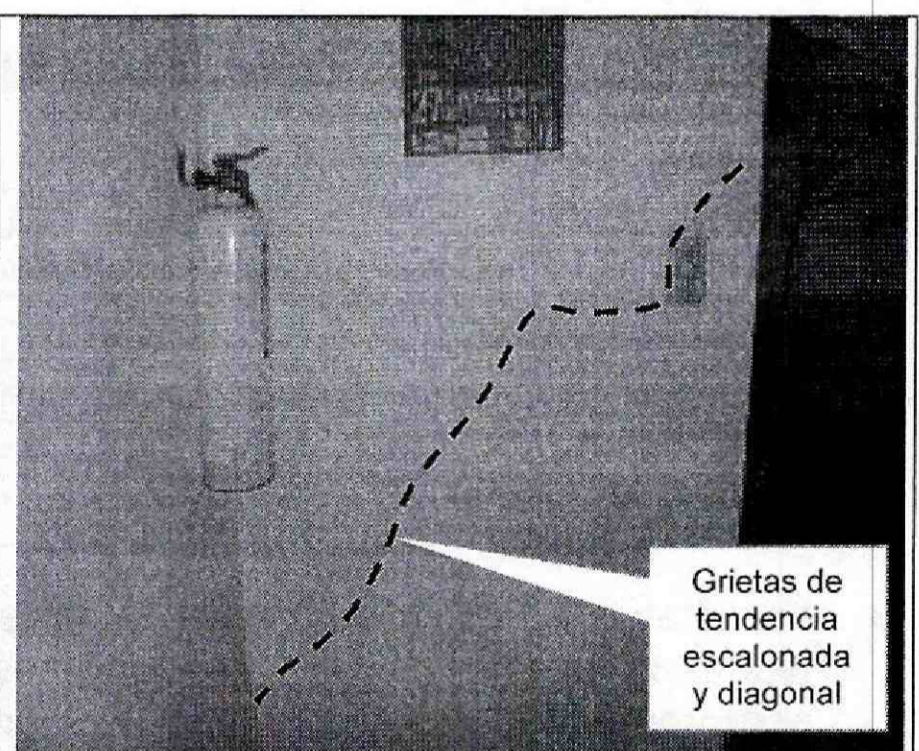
Grietas de tendencia diagonal y horizontal, de longitud entre 0.5 y 2m, con abertura entre 0,1 y 3cm en muro de cerramiento, primer nivel, costado Nor-occidental de la edificación 2, predio de la Calle 95 No. 13-50 AP.
